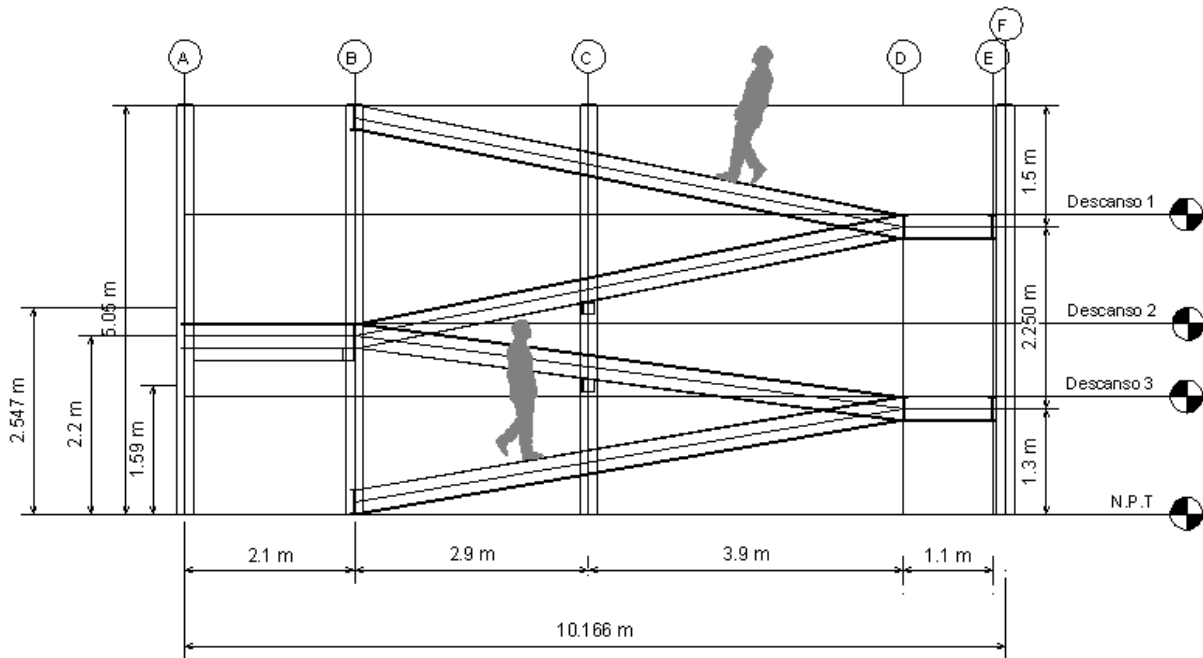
Detalle de rampas de acceso al puente peatonal San Bartolo (vista lateral)
